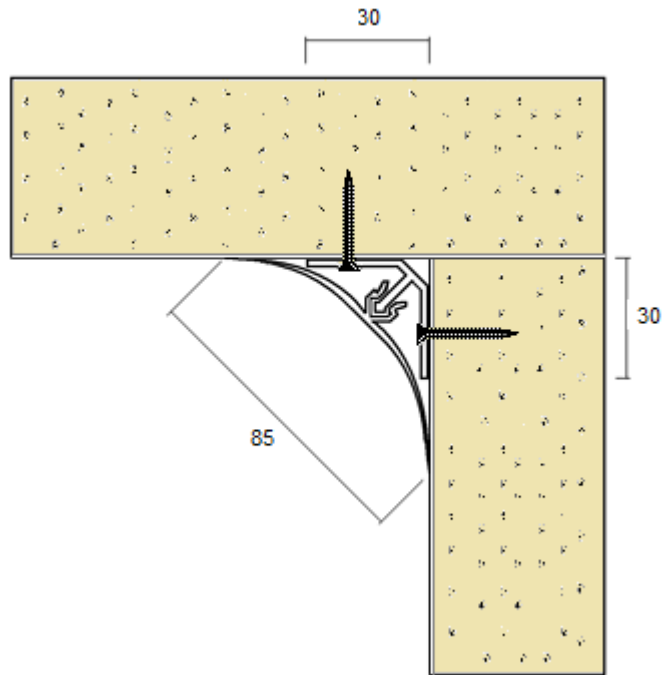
Profil d'angle vertical et plafond avec support (en mm)
